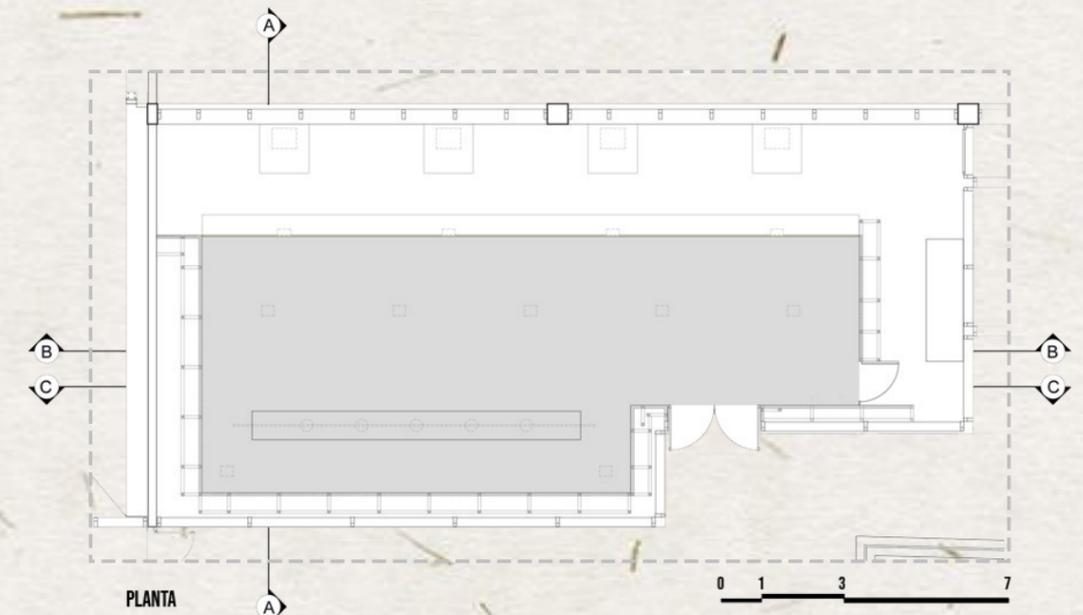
Planta da exposição #Tuiteratura. Fonte: Archdaily, 2022.
